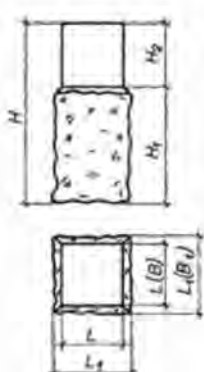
Roxor v betonovém bloku (základní odlehčená stabilizace)
